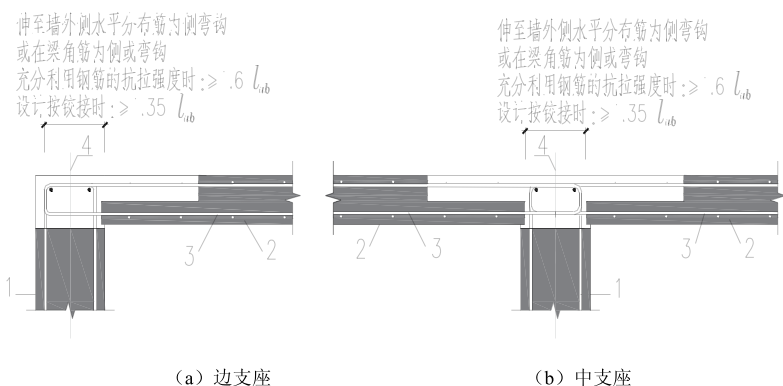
变阶预制混凝土板支座构造示意图
